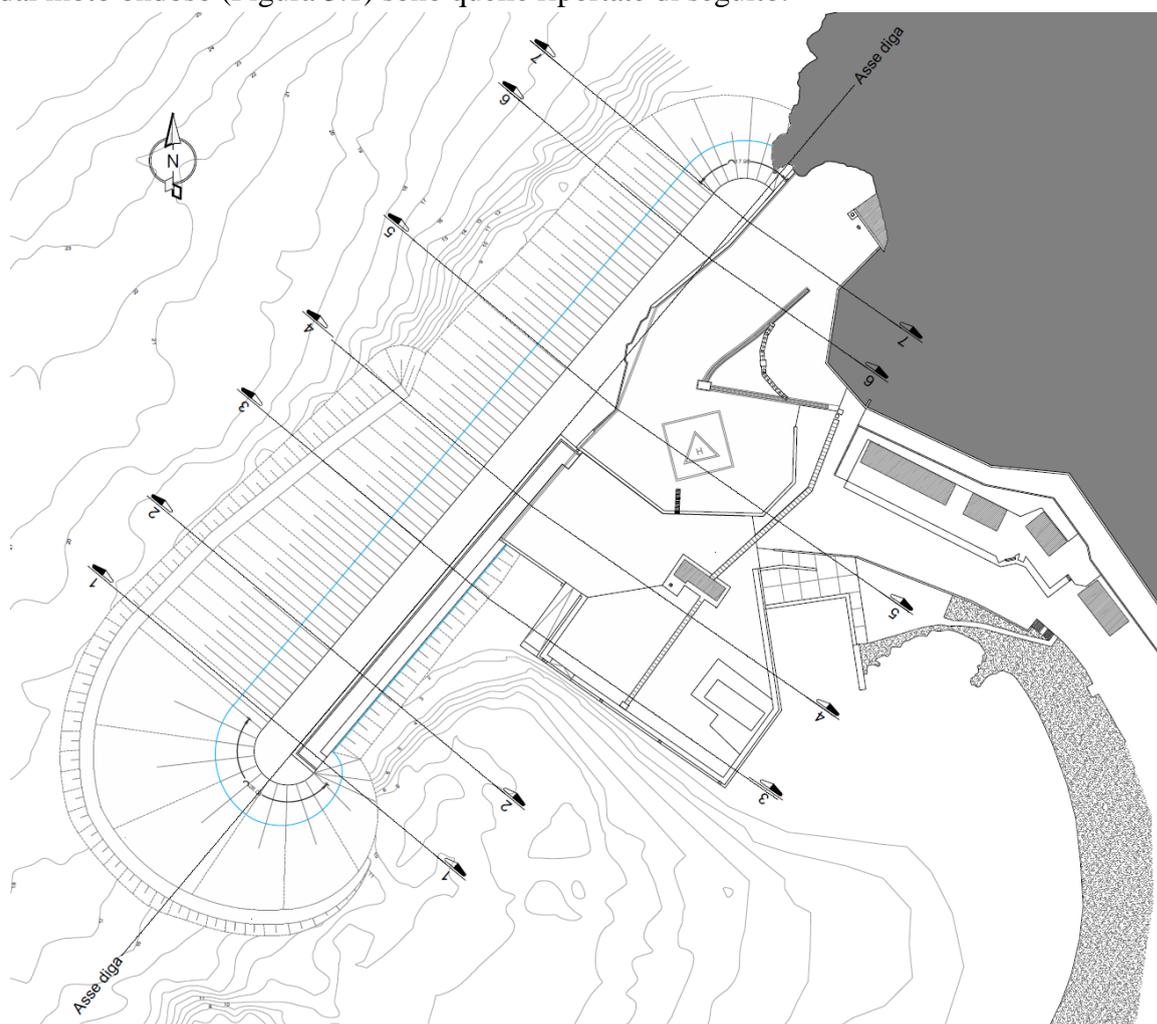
Planimetria di progetto con indicazione dell'ubicazione delle sezioni tipo
